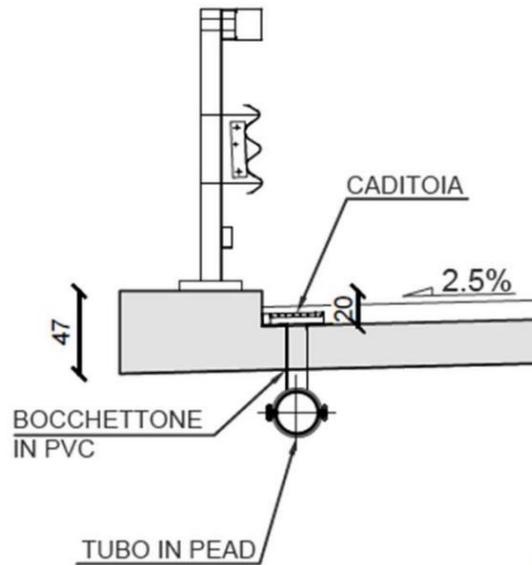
Tratti in viadotto – drenaggio con caditoia
